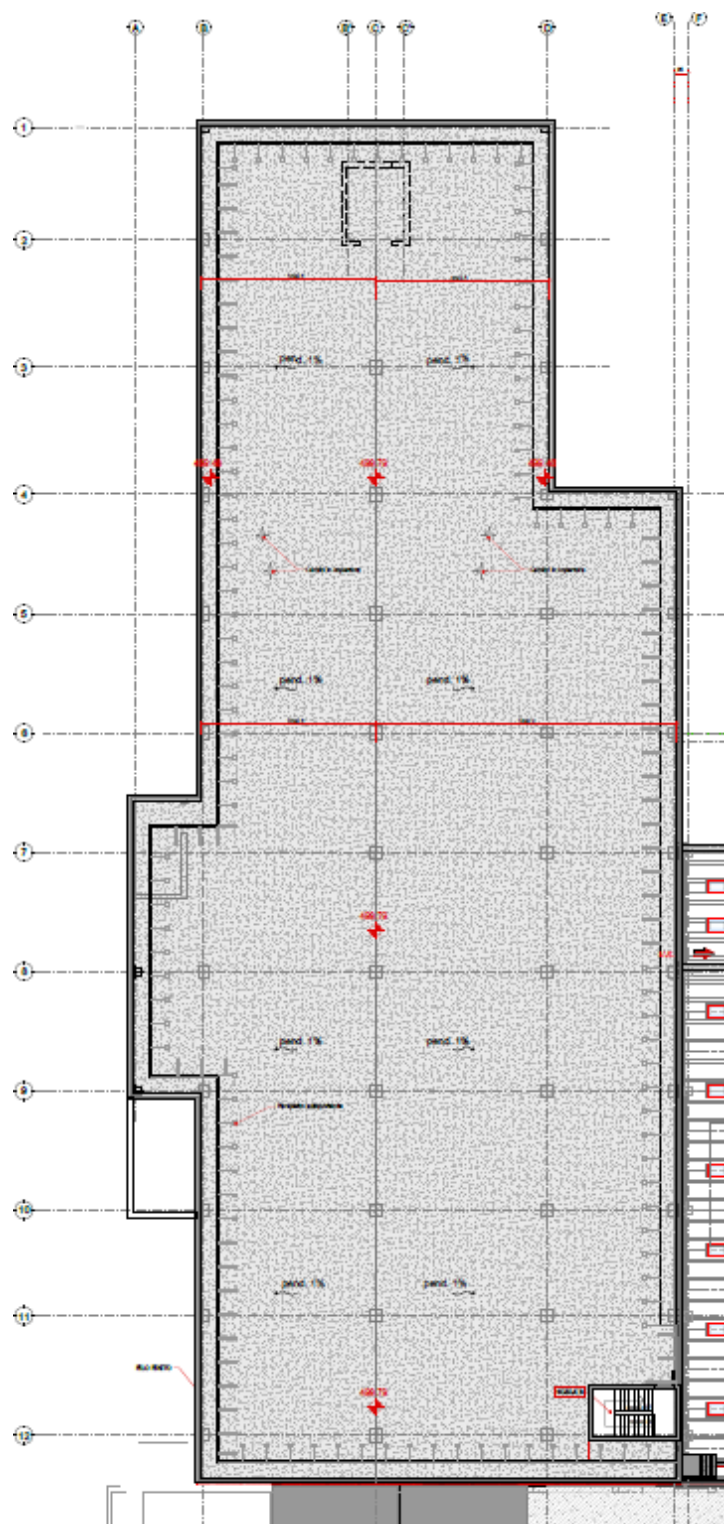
Planimetria architettonica piano P3 (copertura) - Fabbricato Ex. Piemonte
